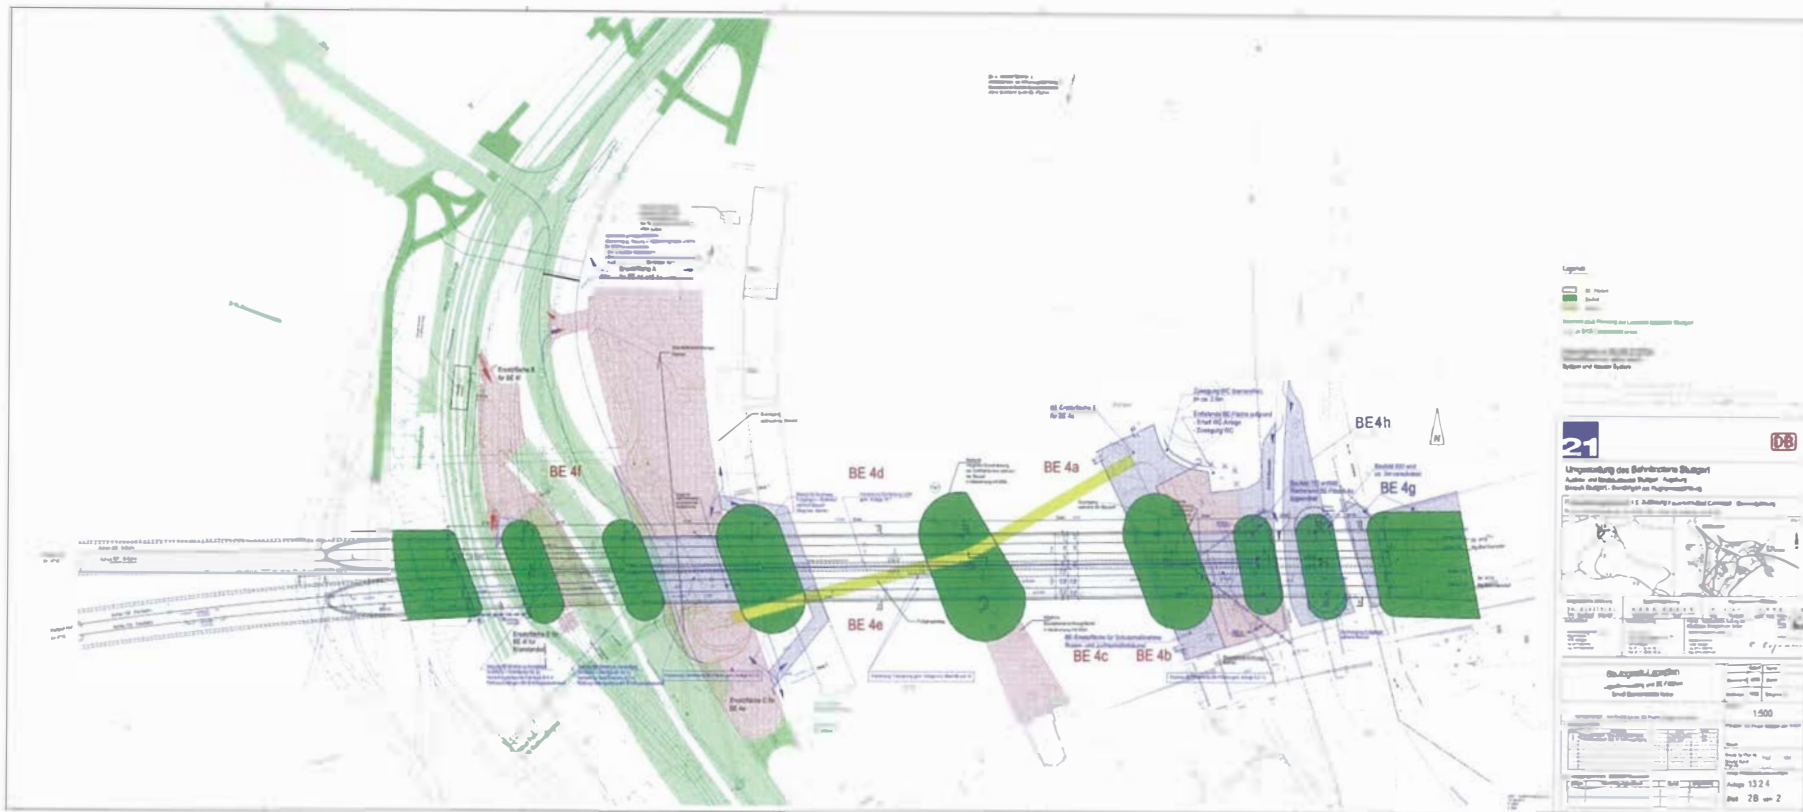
Baulogistik-Lageplan Bereich Eisenbahnbrücke Neckar. Anlage 13.2.4 Blatt 2B von 2. (Stand 20.05.2014)
